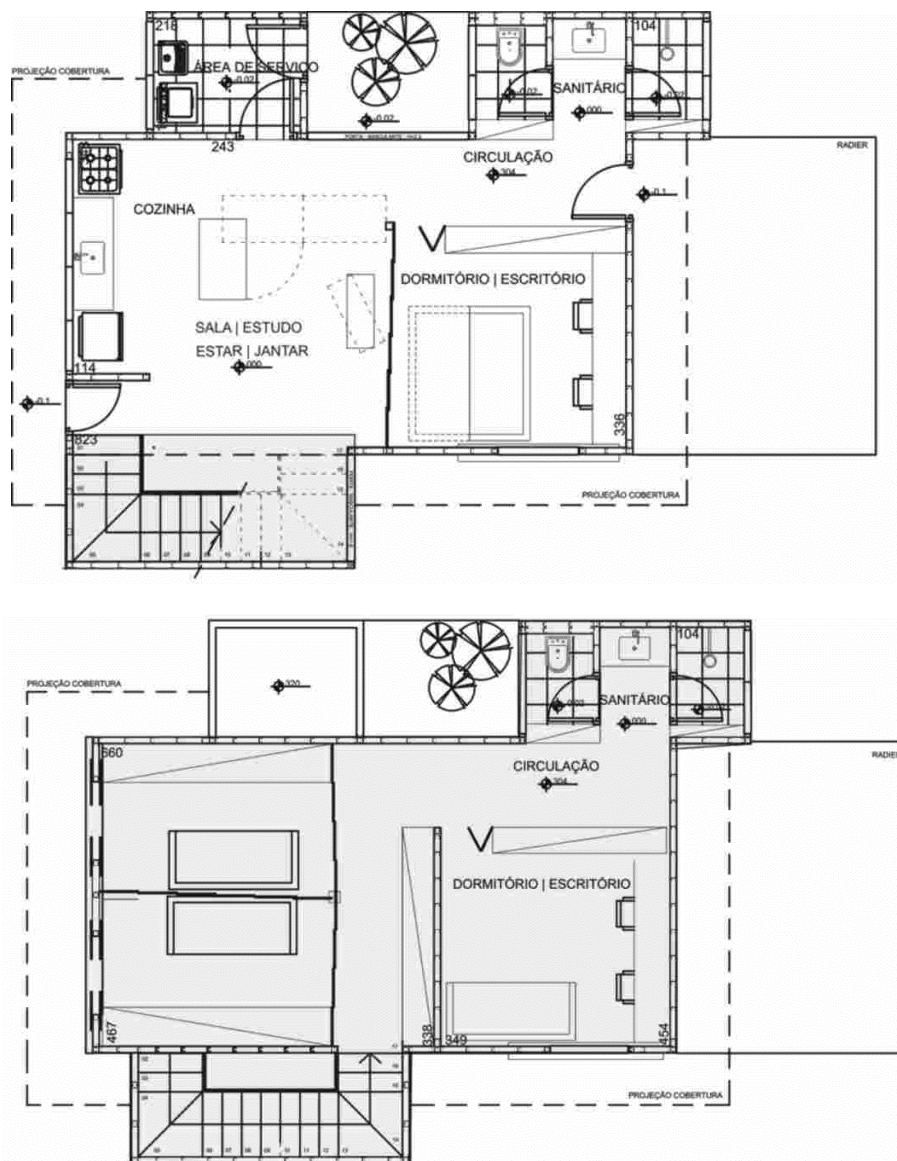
Planta térrea e superior da expansão vertical da unidade MORA [1], com 98 m<sup>2</sup>. Fonte: autores.
